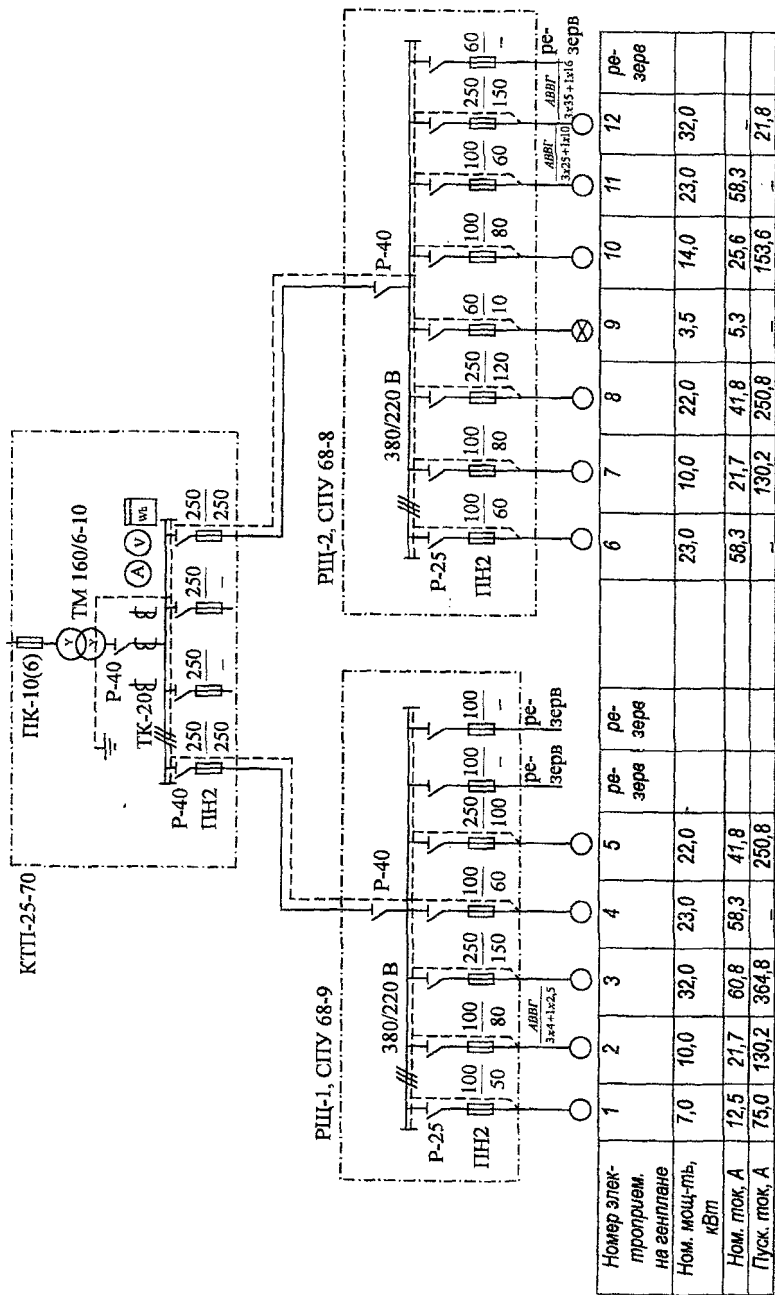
Принципиальная схема электроснабжения строительной площадки
